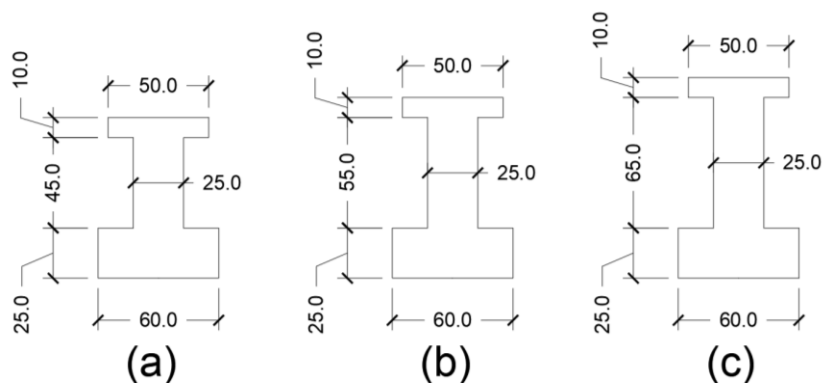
Seção transversal de vigas de concreto armado: (a) vão de 10 m, (b) vão de 15 m, (c) vão de 20 m (dimensões em centímetros).
